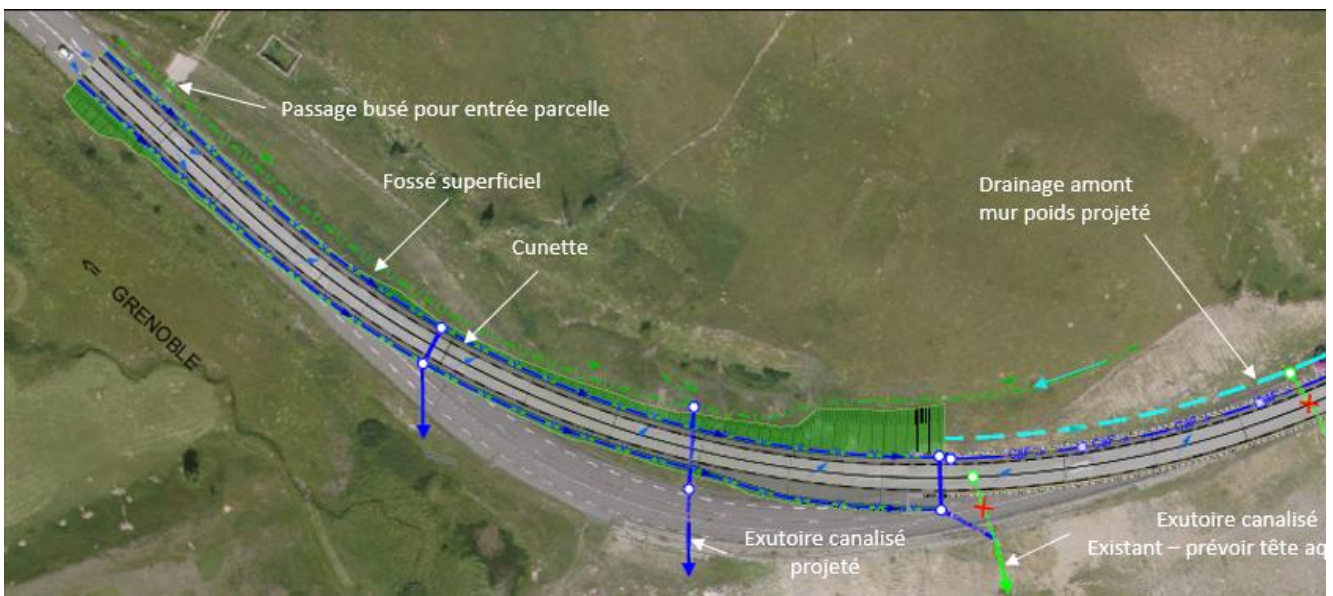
Extrait du plan assainissement des ouvrages amont projetés du paravalanche dir. GRENOBLE.
